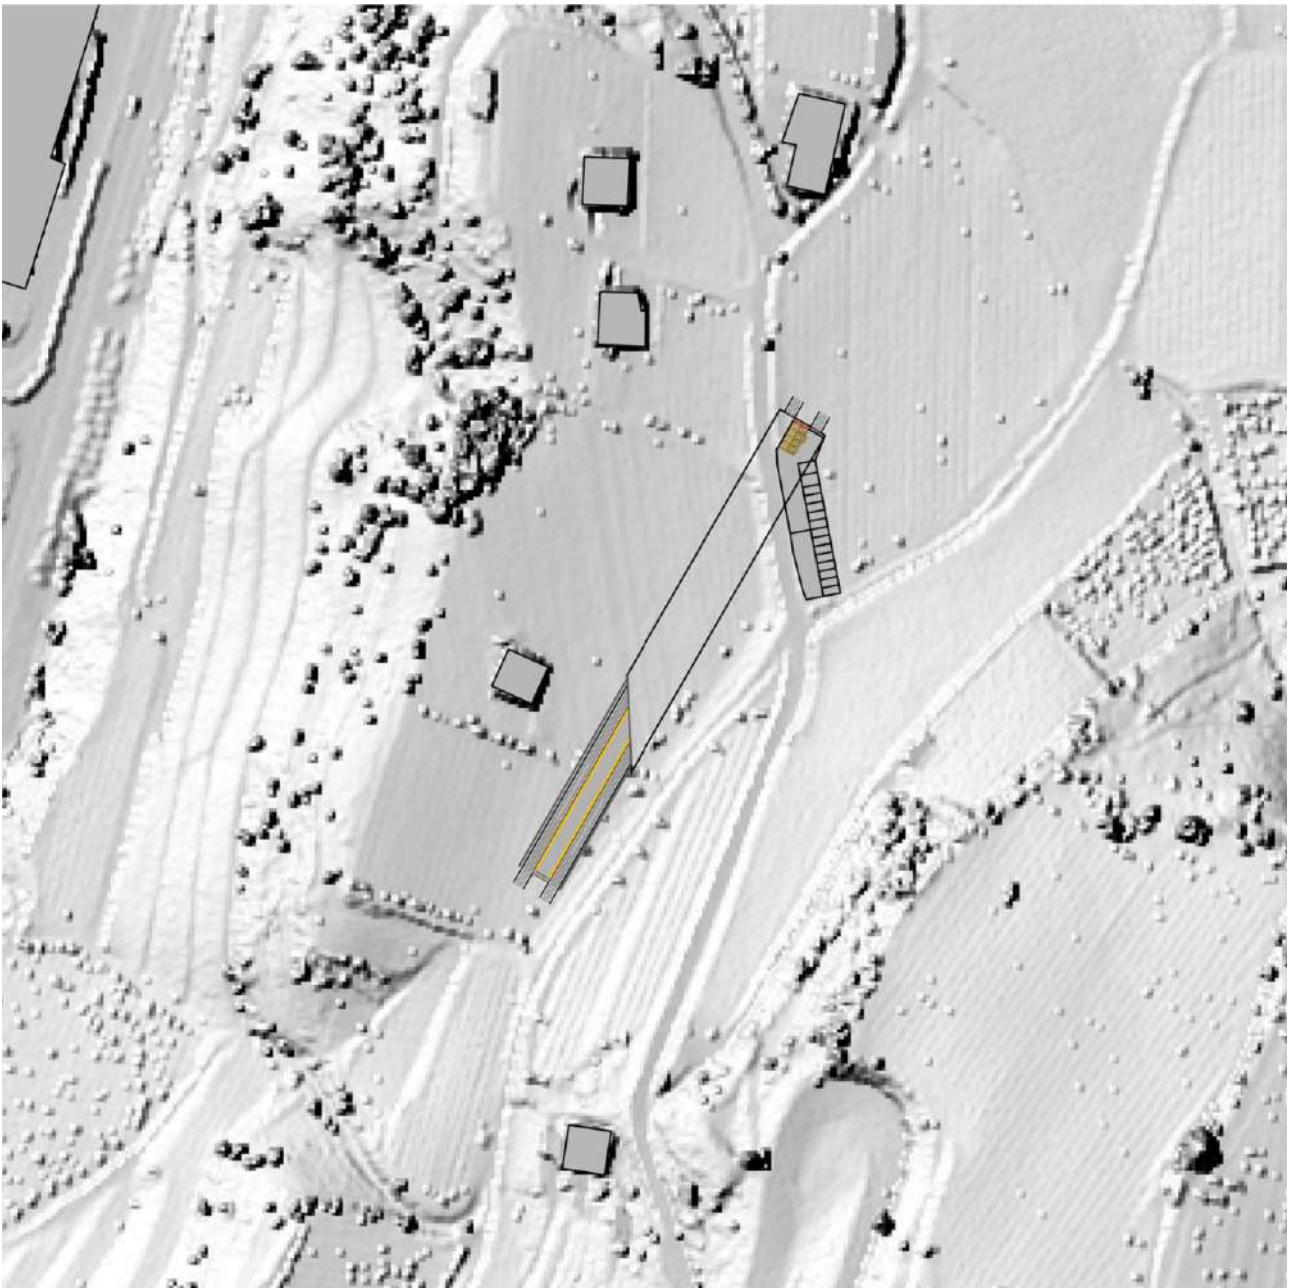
Meano: Planimetria generale con indicazione dei parcheggi e della parte interrata dell'impianto
